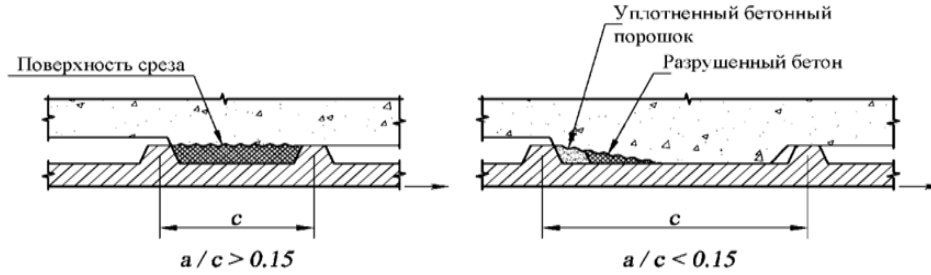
Виды разрушений бетонных консолей между поперечными ребрами арматурной стали
